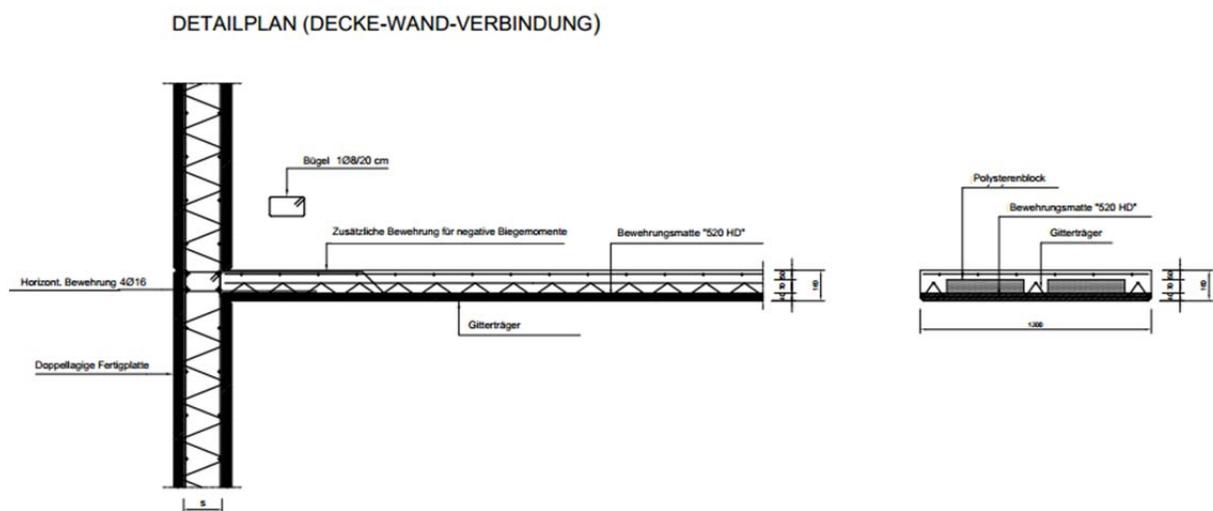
Typisches Tragwerksdetail für Anschluss der Stahlbetonwand an Stockwerksdecke (vertikaler Schnitt).
